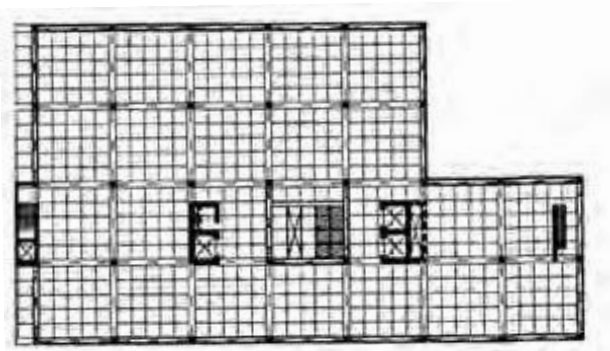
O.M.A., Morgan Bank (1985), vue en plan d'un étage typique
